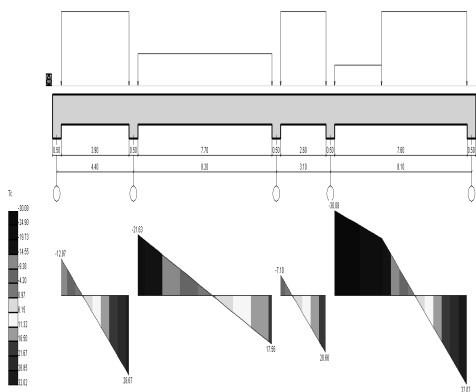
Епюра поперечних сил в залізобетонній балці після реконструкції
